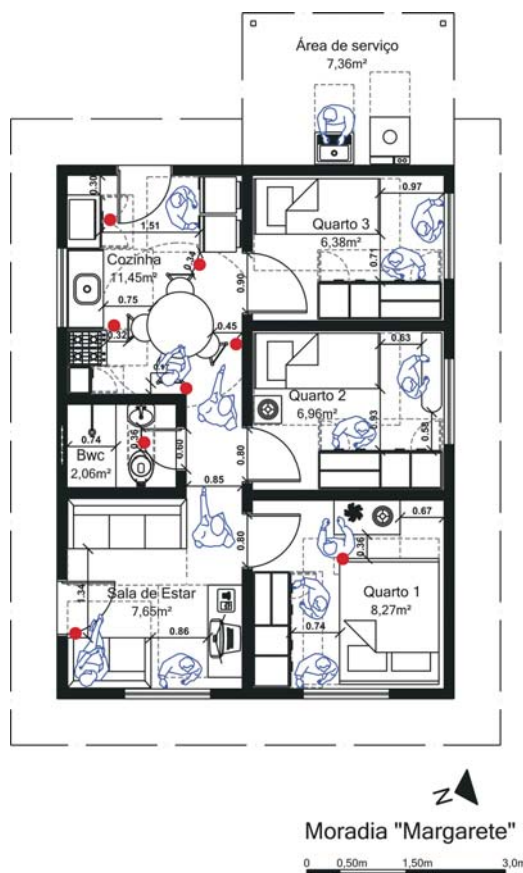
Arranjo do mobiliário da moradia "Margarete" em planta
